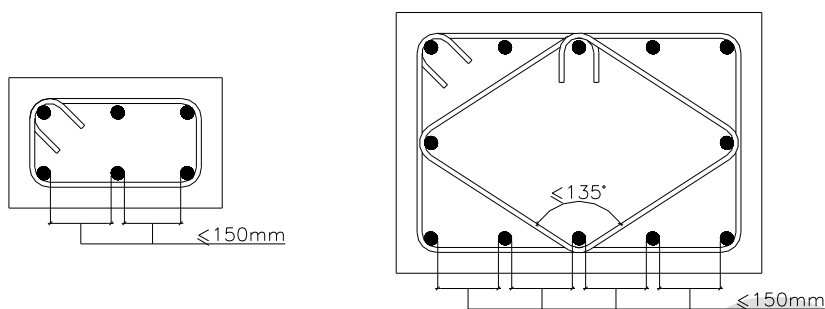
Separación máxima de barras sin apoyo lateral.
